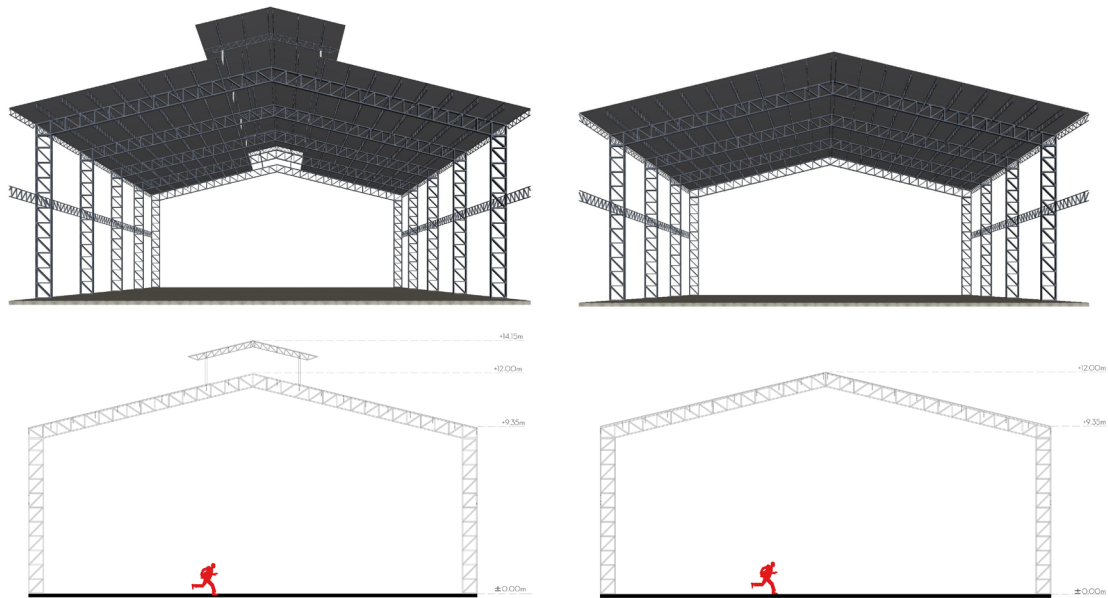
Estructura tipo estado actual cercha industria. Fuente: Elaboración de los autores.
